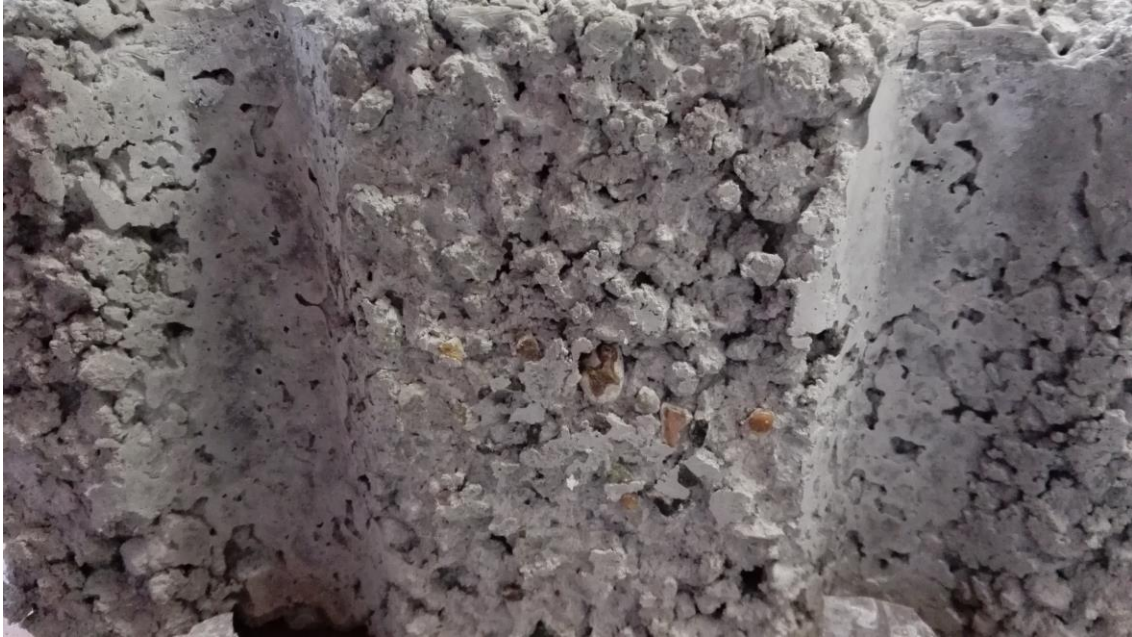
Desprendimiento completo del bloque de hormigón, Piedra 1
